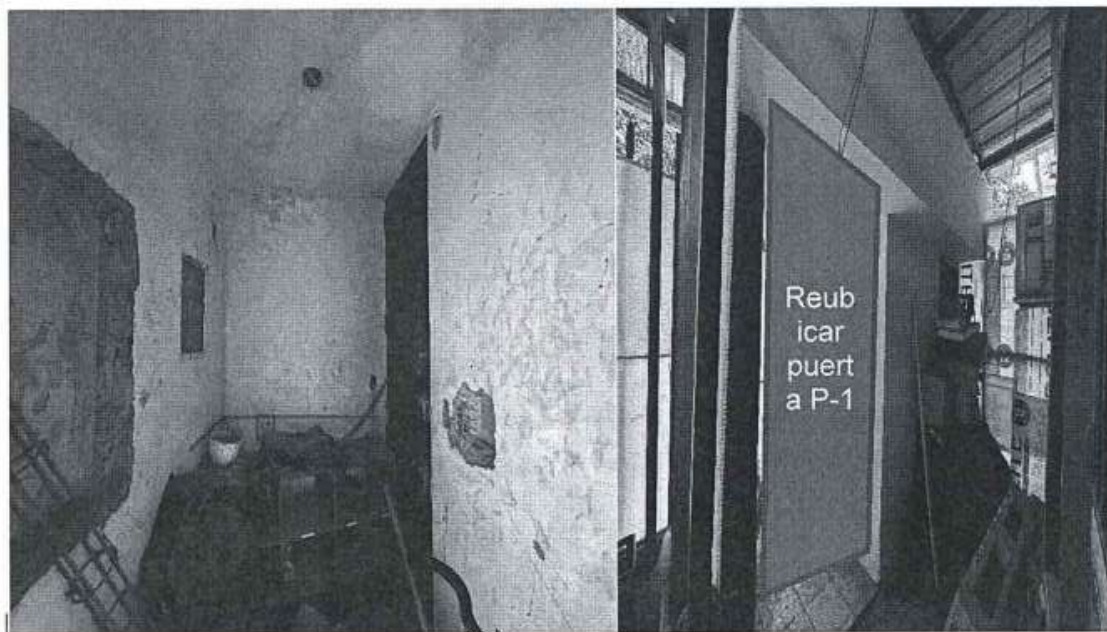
y 9 : Imagen de Puerta P-1 a reubicar y vano donde se colocará la puerta PR
